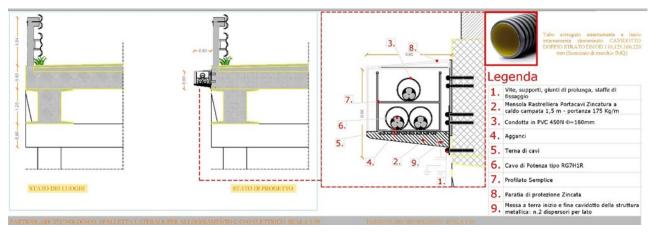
Schema Tipo attraversamento Cavidotto su Spalla Ponte
